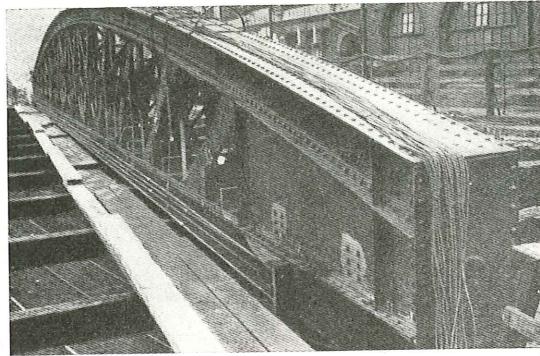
Refuerzo de vigas en celosía de 39 metros de luz, en Livery Street, Birmingham. Solución análoga a la de la figura 14.
